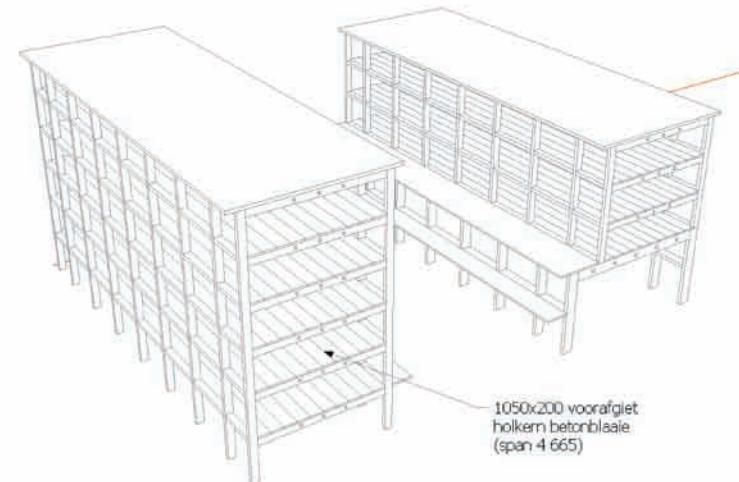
Voorgiet holkern betonblaai op in-situ balke
